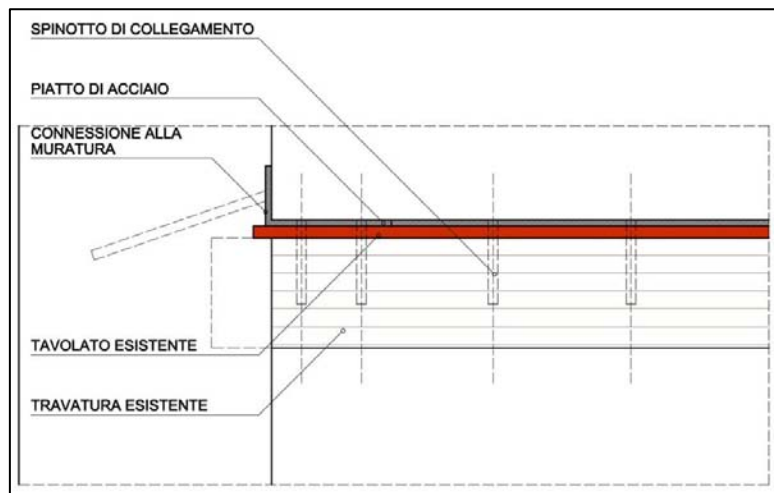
Sezione longitudinale di solaio consolidato con profili metallici sottili
